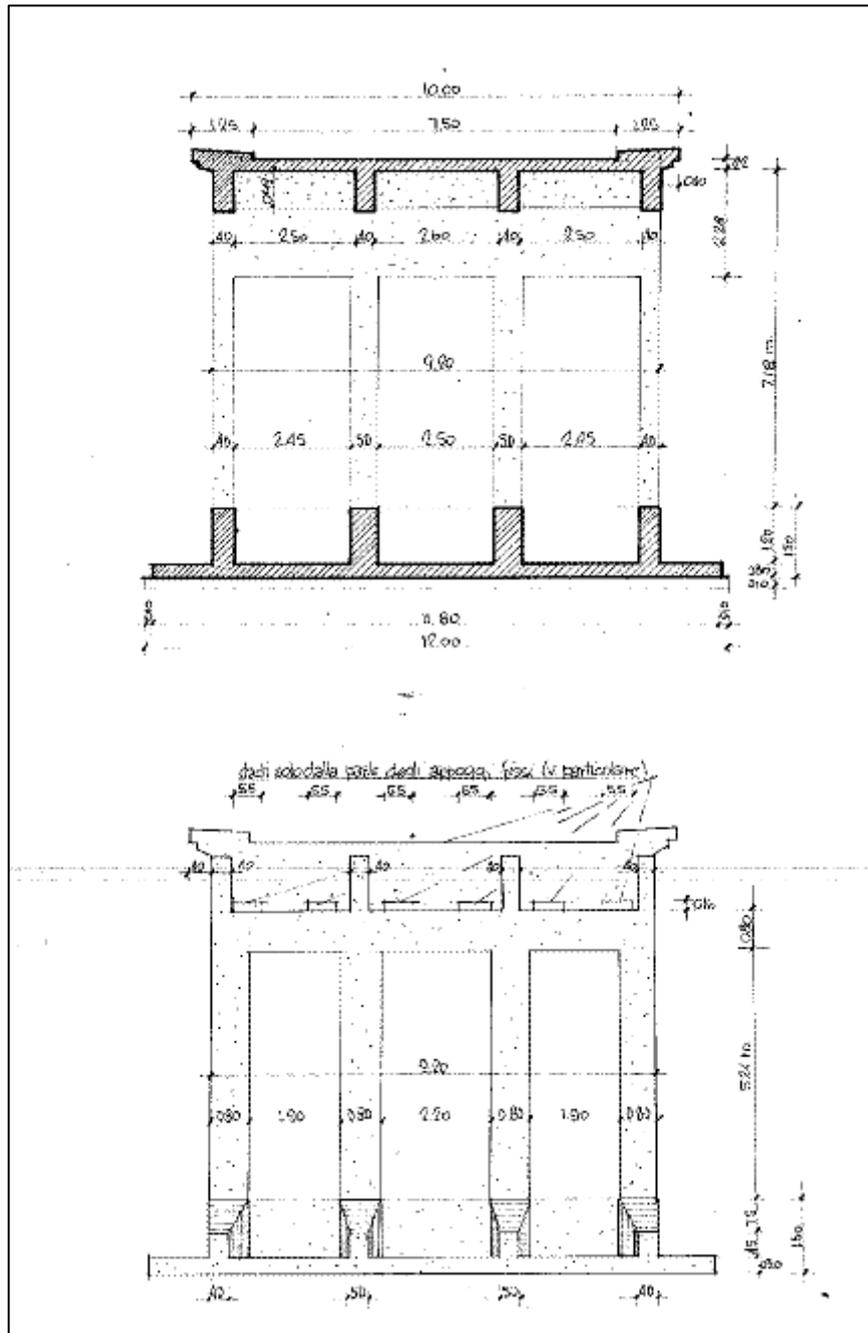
As-built carpenteria spalla e pila
